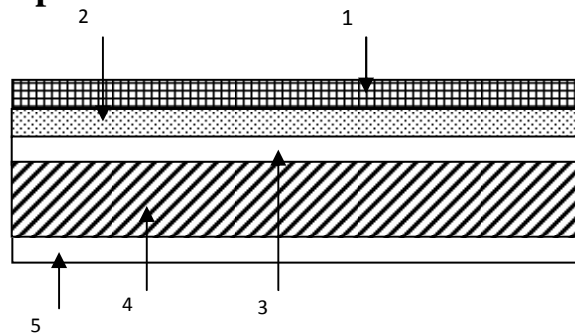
Coupe d'un plancher étage courant et RDC et S-S
